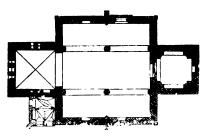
Reinberg. Kirche. Grundriss. 1:667.
